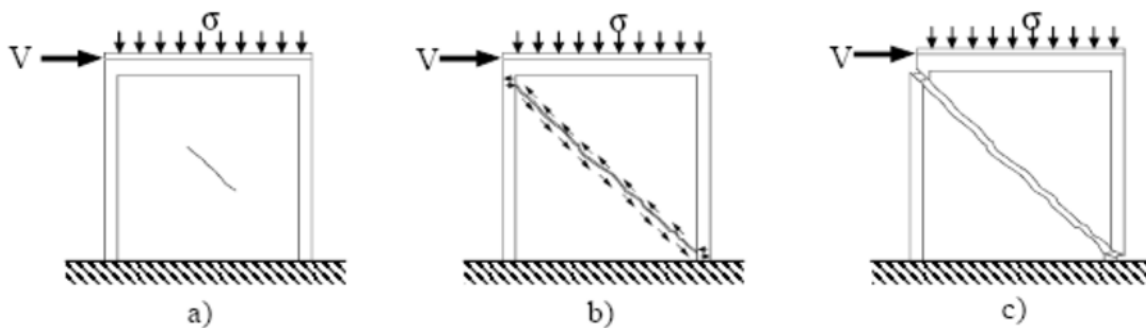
Patrón de daño ante fuerzas horizontales.
